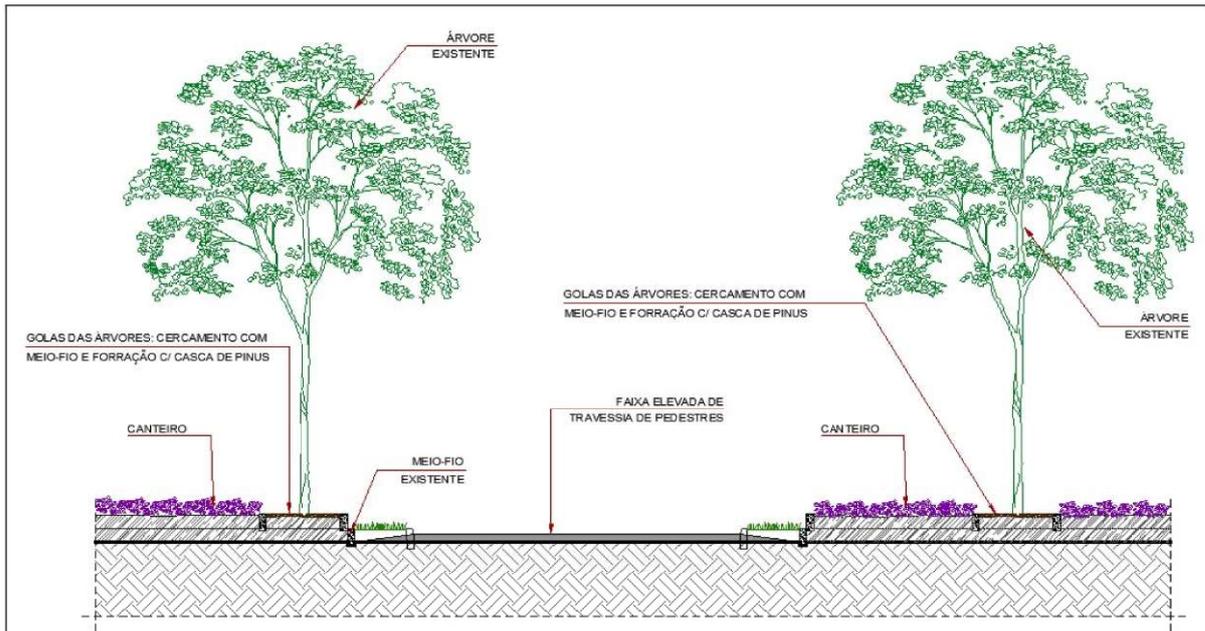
detalhe (seção longitudinal) do trecho entre canteiros localizado na faixa elevada de pedestres – em direção ao calçadão da Rua. Geraldo Pereira (fonte: Serpenge)
